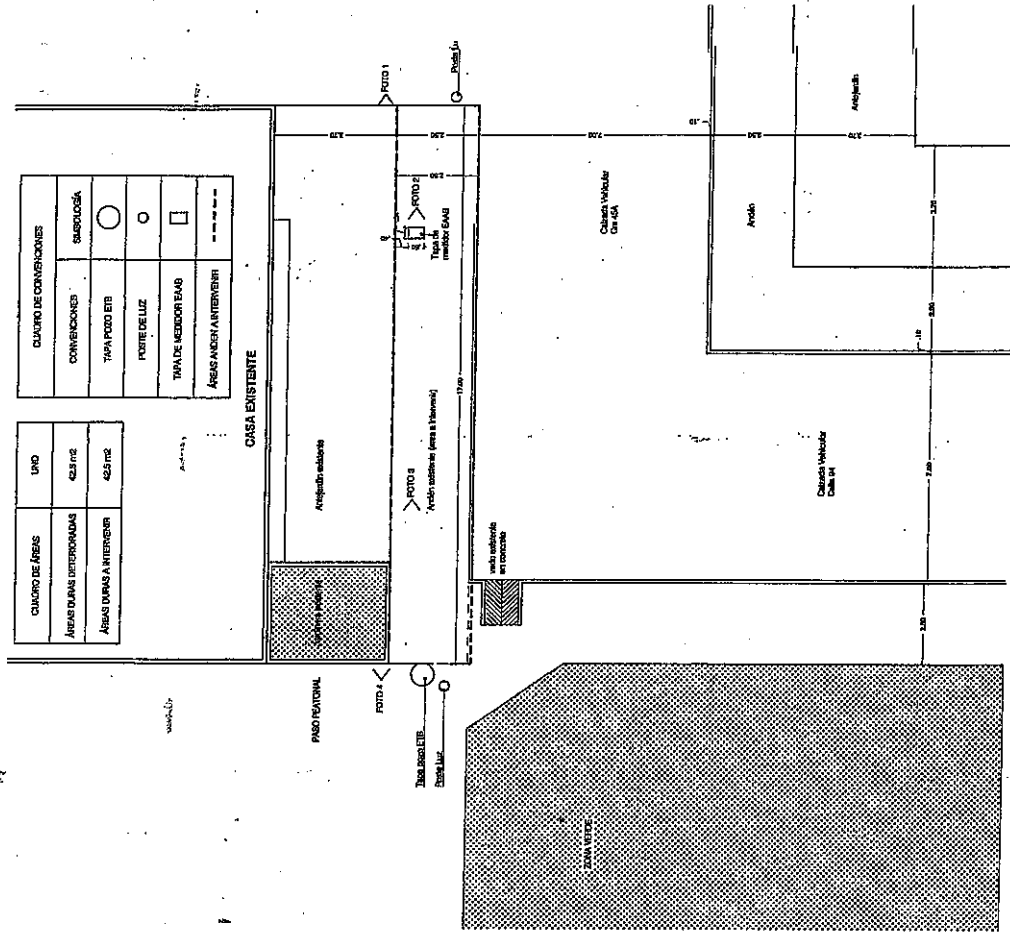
FOTO Y LEVANTAMIENTO ESTADO ACTUAL
